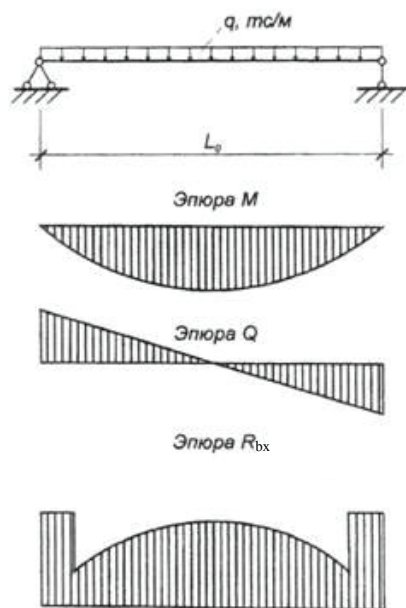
Расчетные и контрольные эпюры для однопролетной железобетонной балки.
